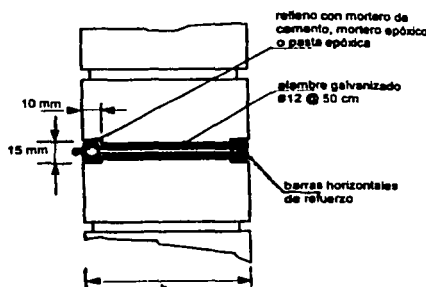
Ejemplo de inserción de barras de refuerzo en las juntas de un muro.
